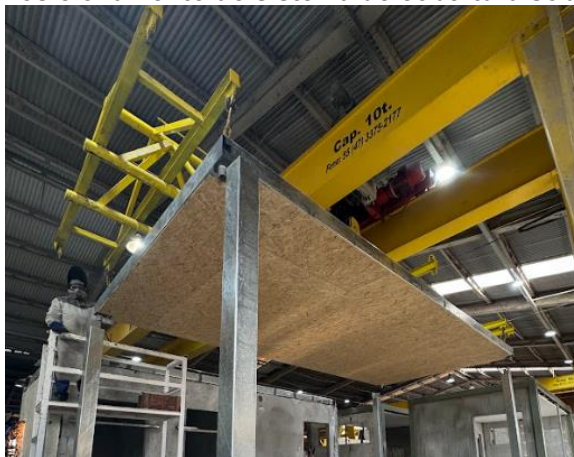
Posicionamento e fixação do pilar na estrutura do módulo
